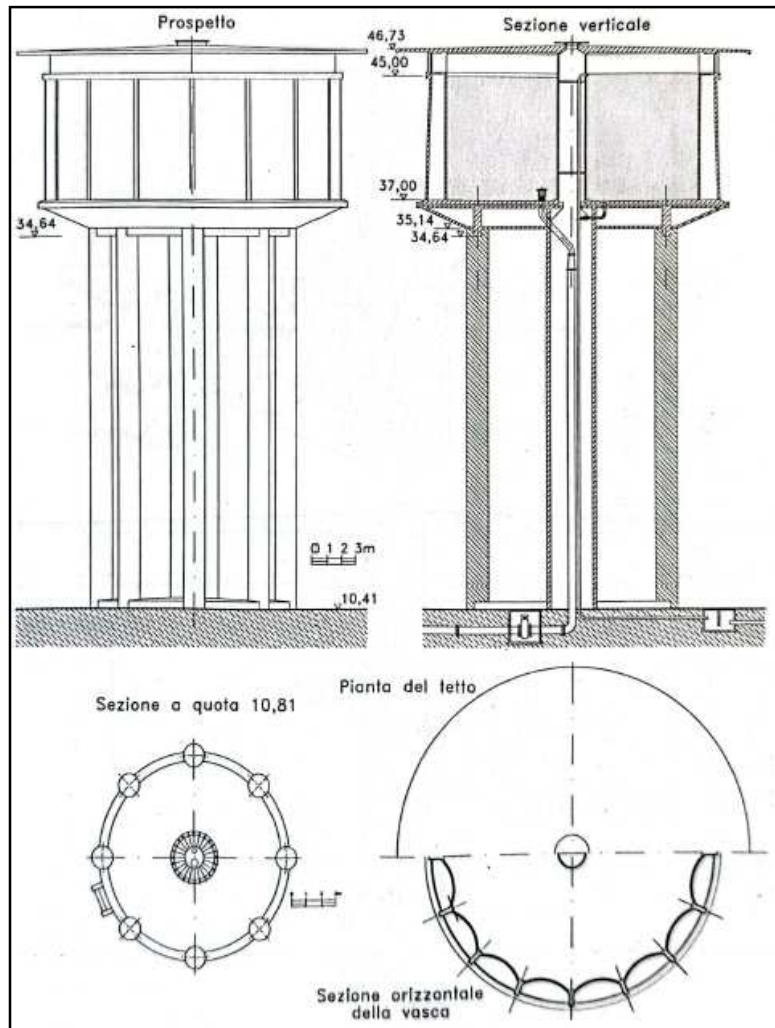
Prospetto generale, sezione verticale e piante, serbatoio Gramsci
